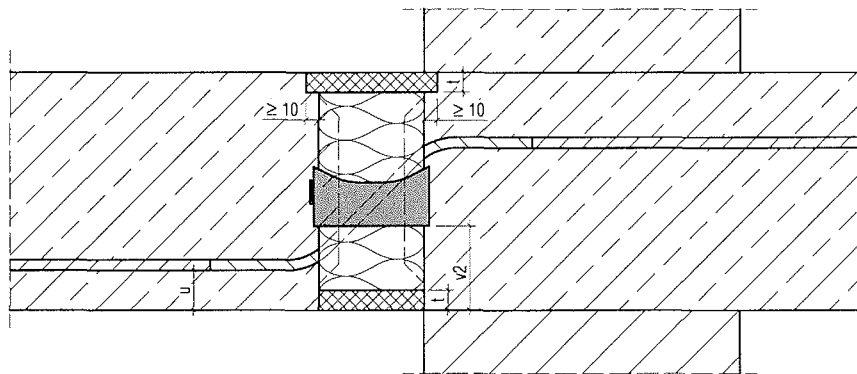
Schöck Isokorb Typ Q (F30/F120)
